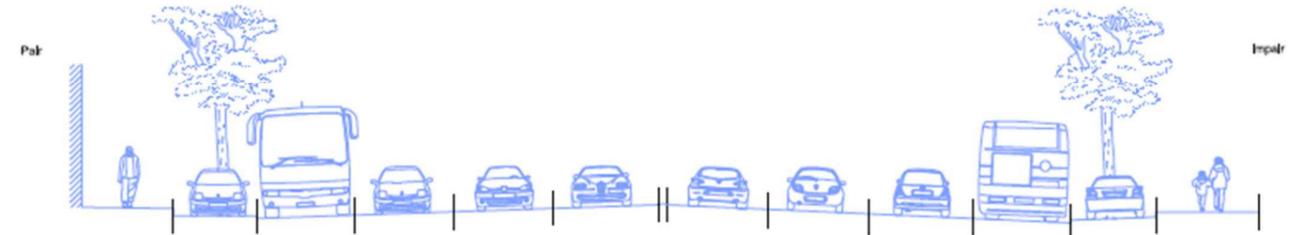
Section carrefour Vache Noire – carrefour Gabriel Péri
